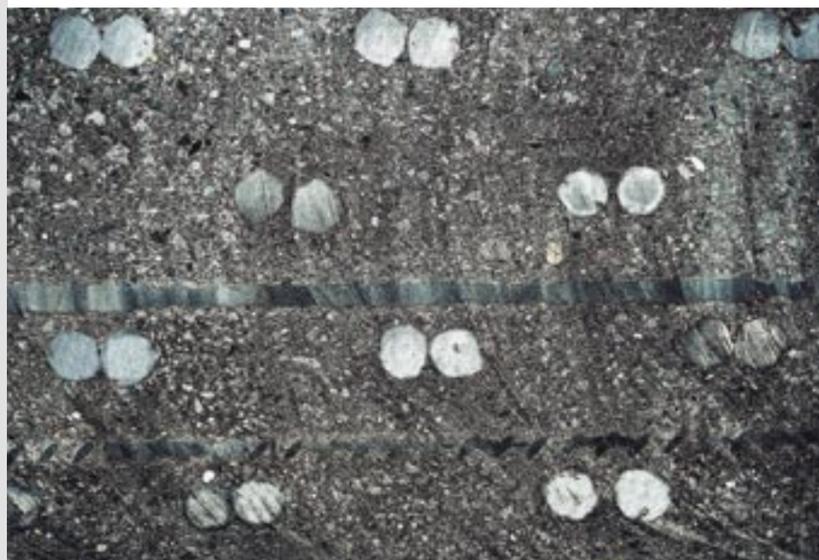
Фрагмент среза модели фундамента из самоуплотняющегося бетона
